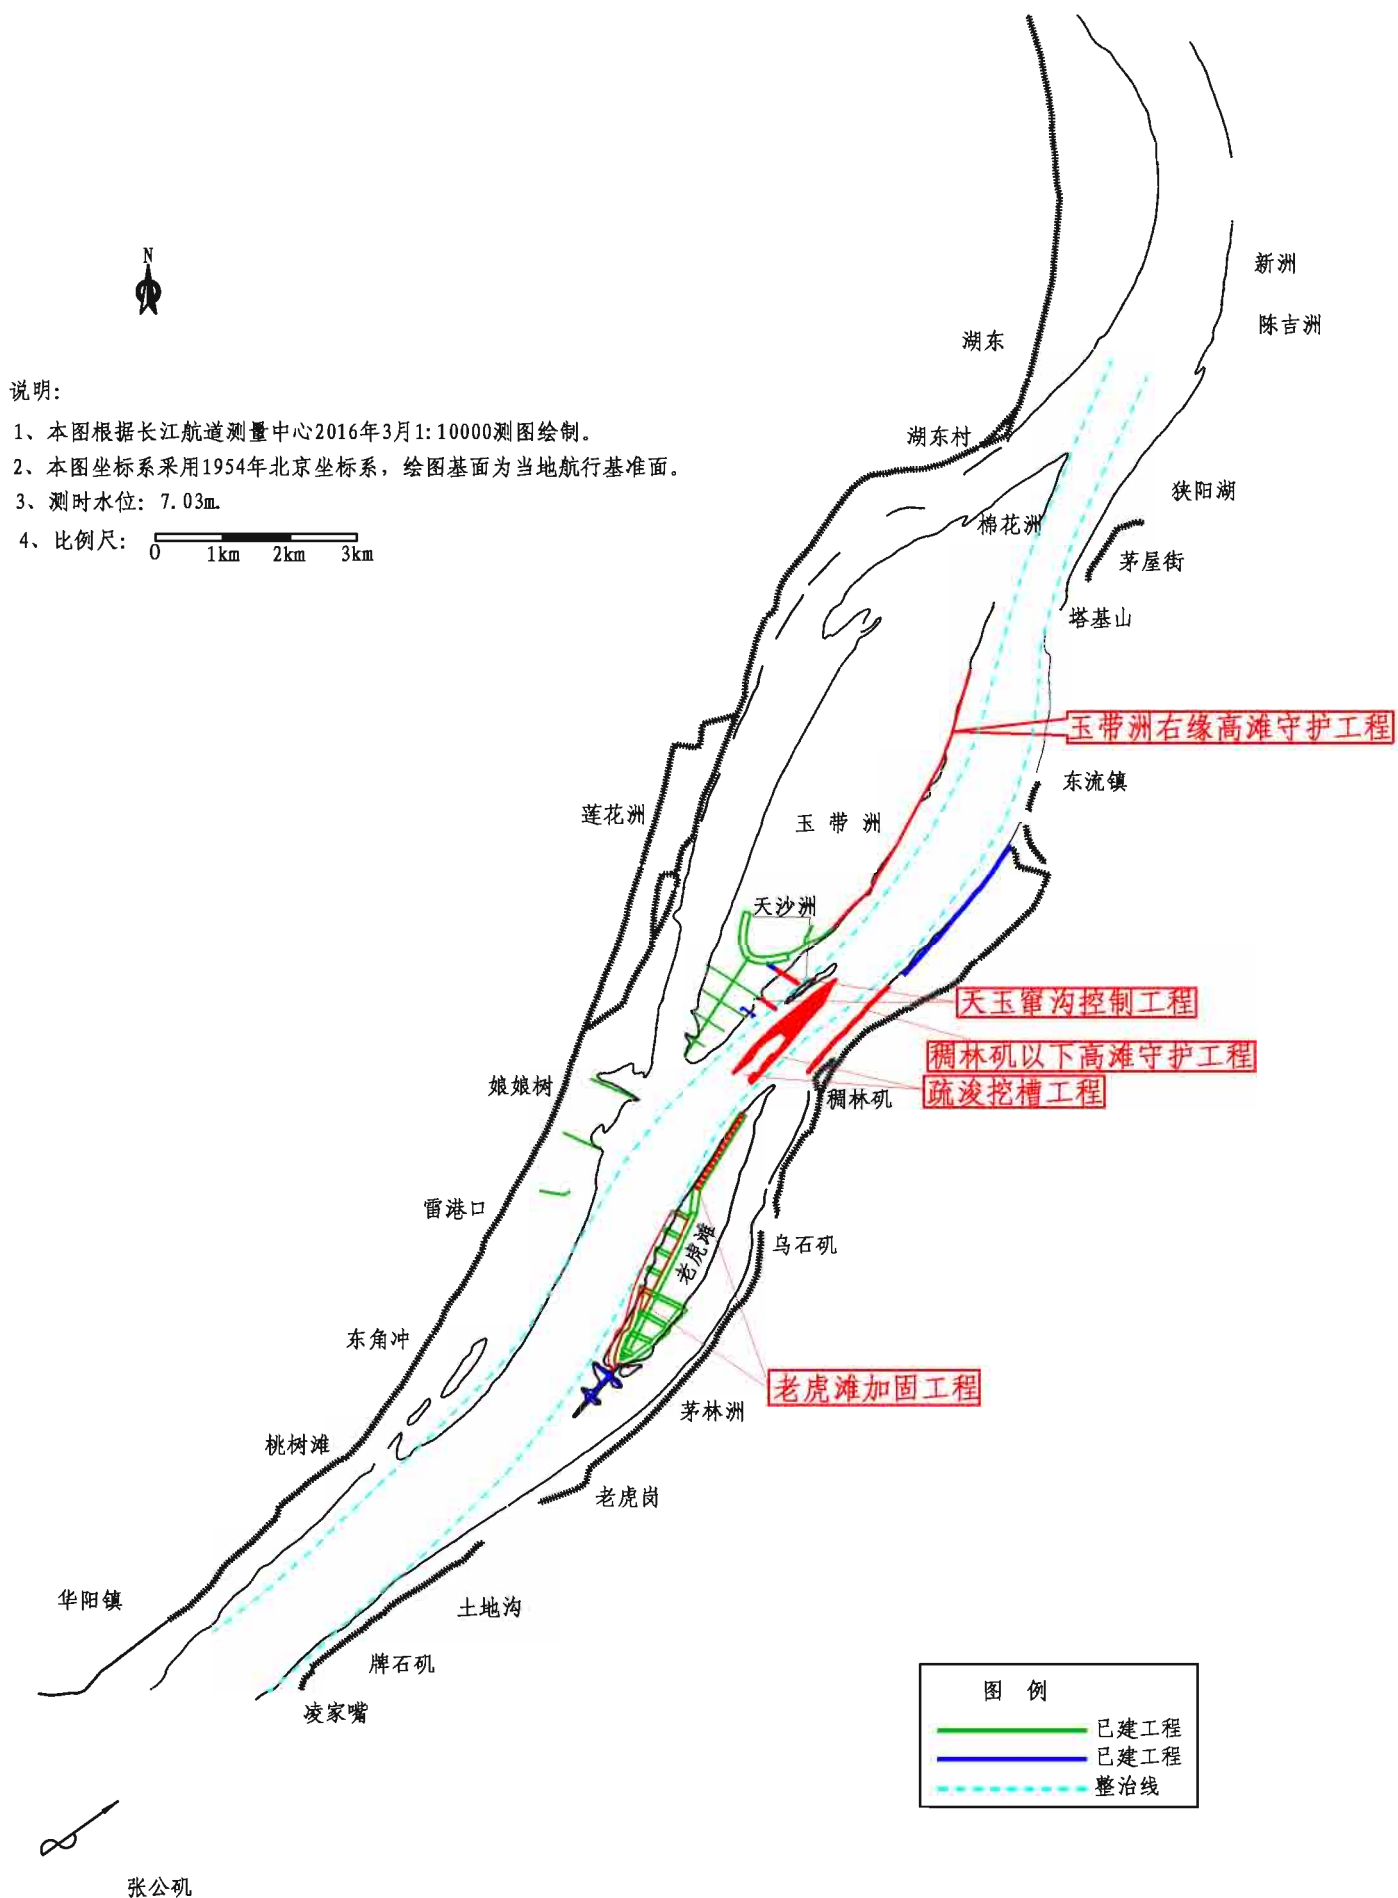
东流水道航道整治工程平面布置示意图(方案一)
